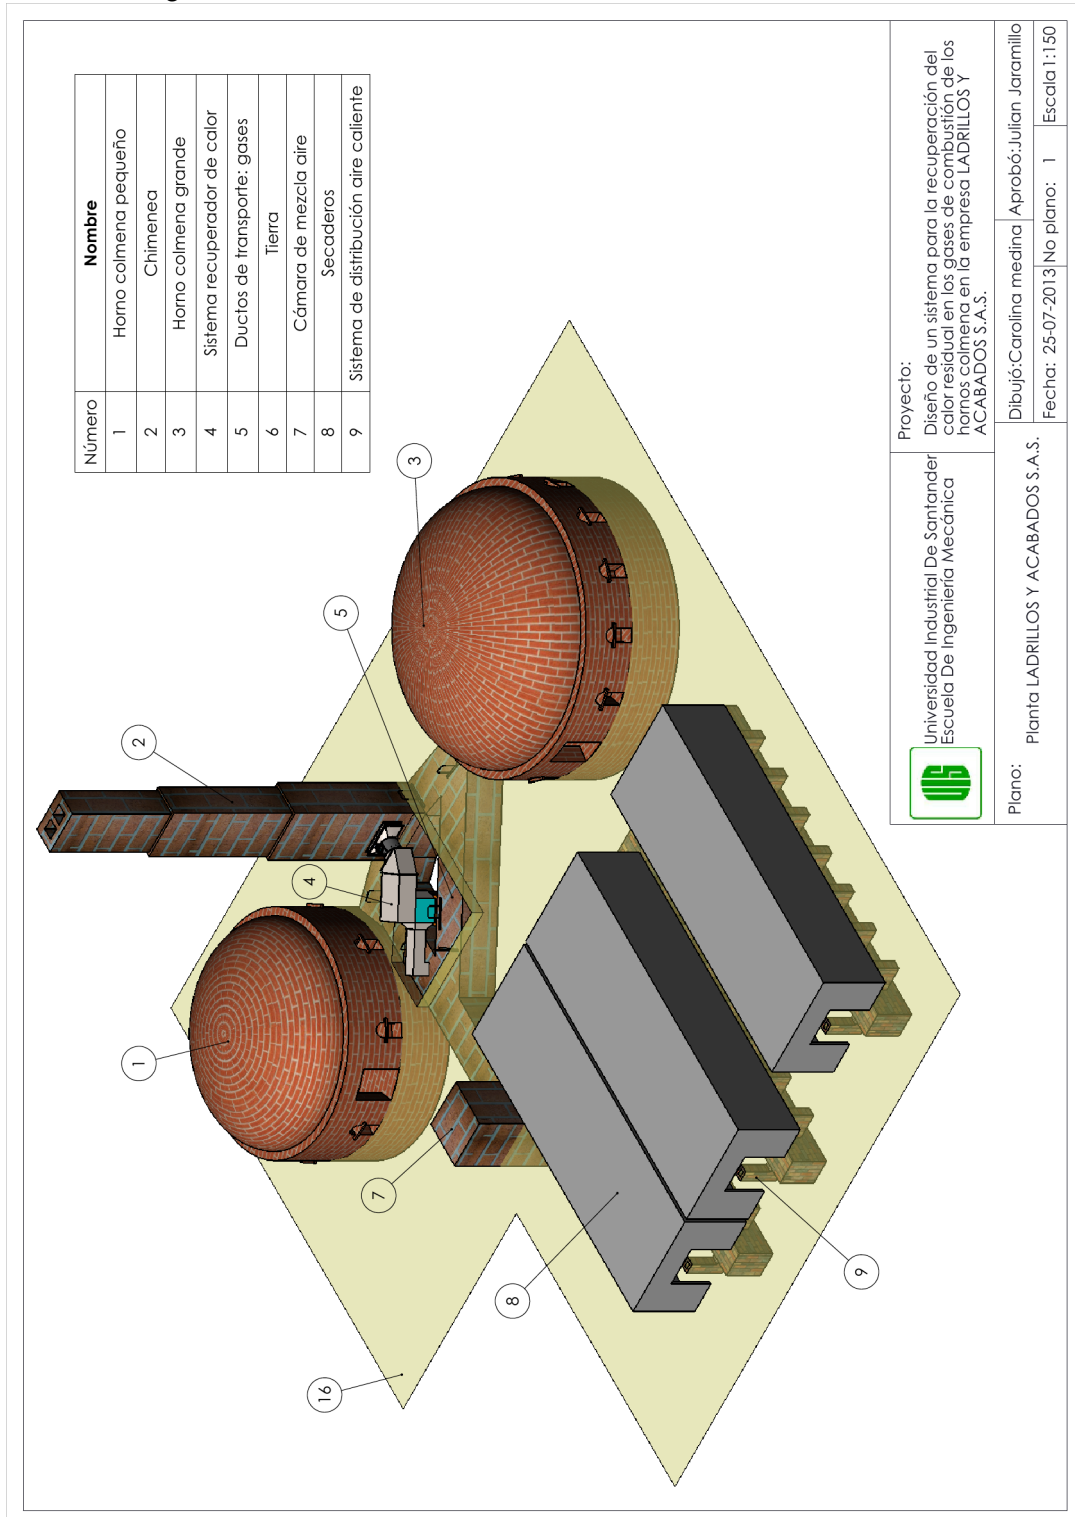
Plano 2. Planta LADRILLOS Y ACABADOS S.A.S.
